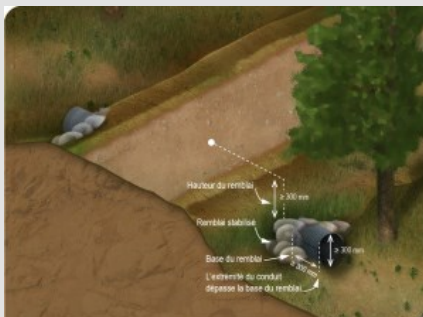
Caractéristiques d'installation d'un conduit de drainage
